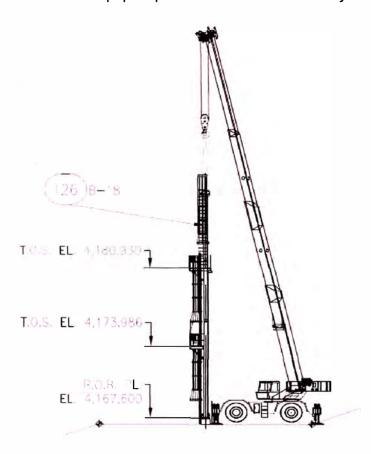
Posición de equipos para maniobra de montaje de la cepa B18
